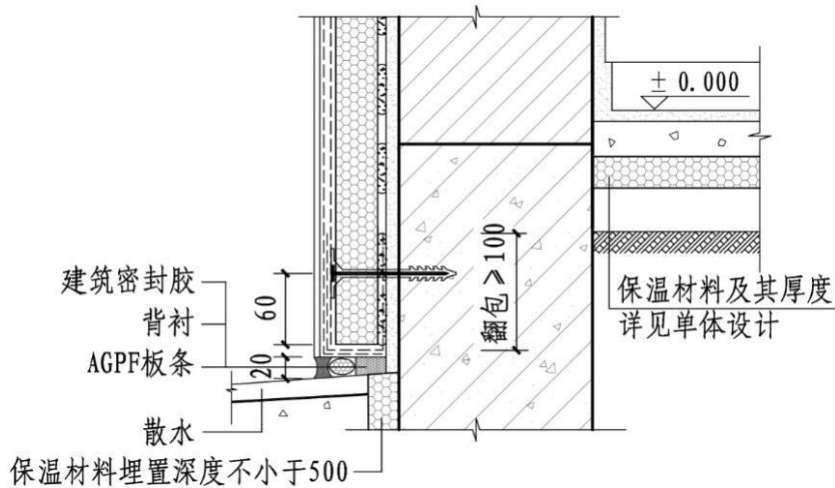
无地下室勒脚部位外保温构造示意图
